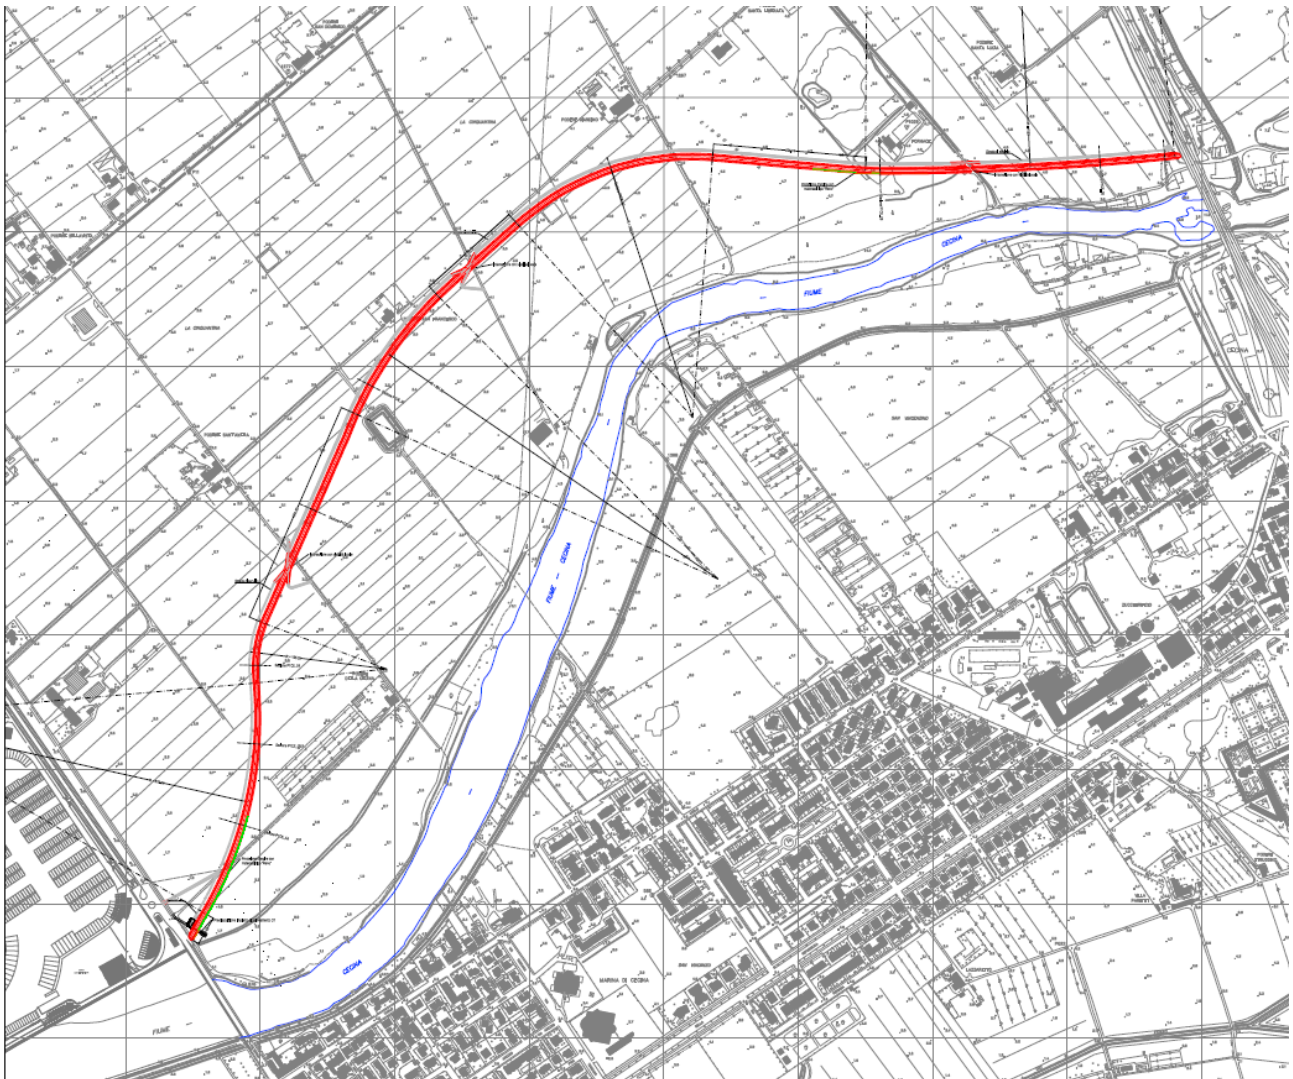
planimetria e sezione ponte sul fiume Cecina in prosecuzione di via Volterra
